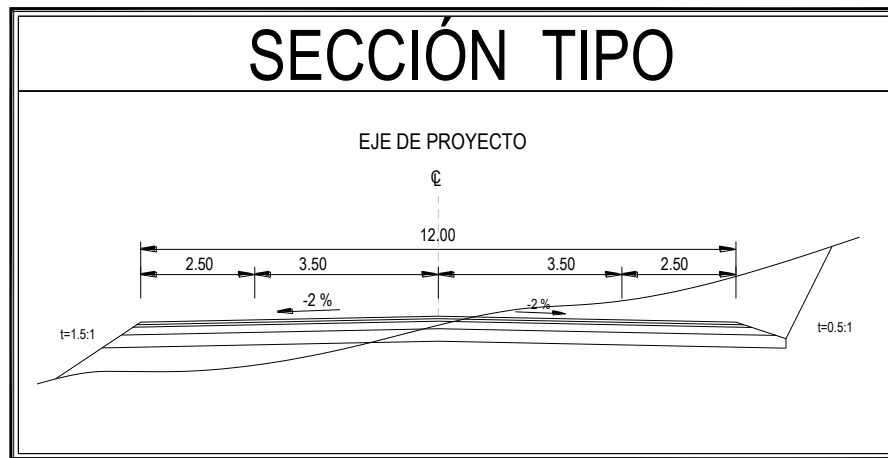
Sección Tipo de la Autopista Pátzcuaro-Lázaro Cárdenas
